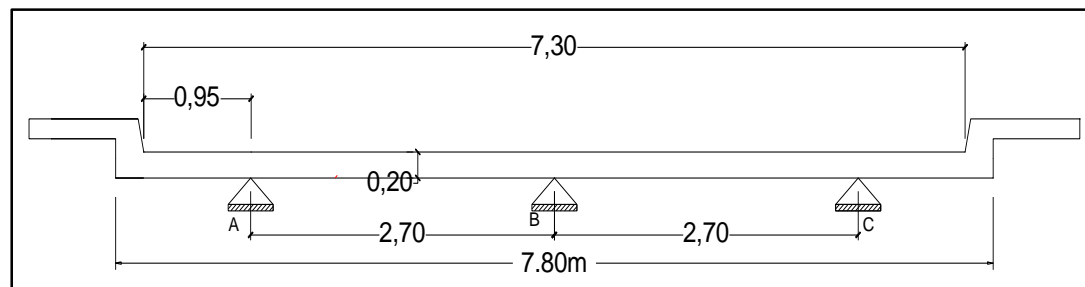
geometría de la losa del tablero (*fuentes elaboración propia*)
